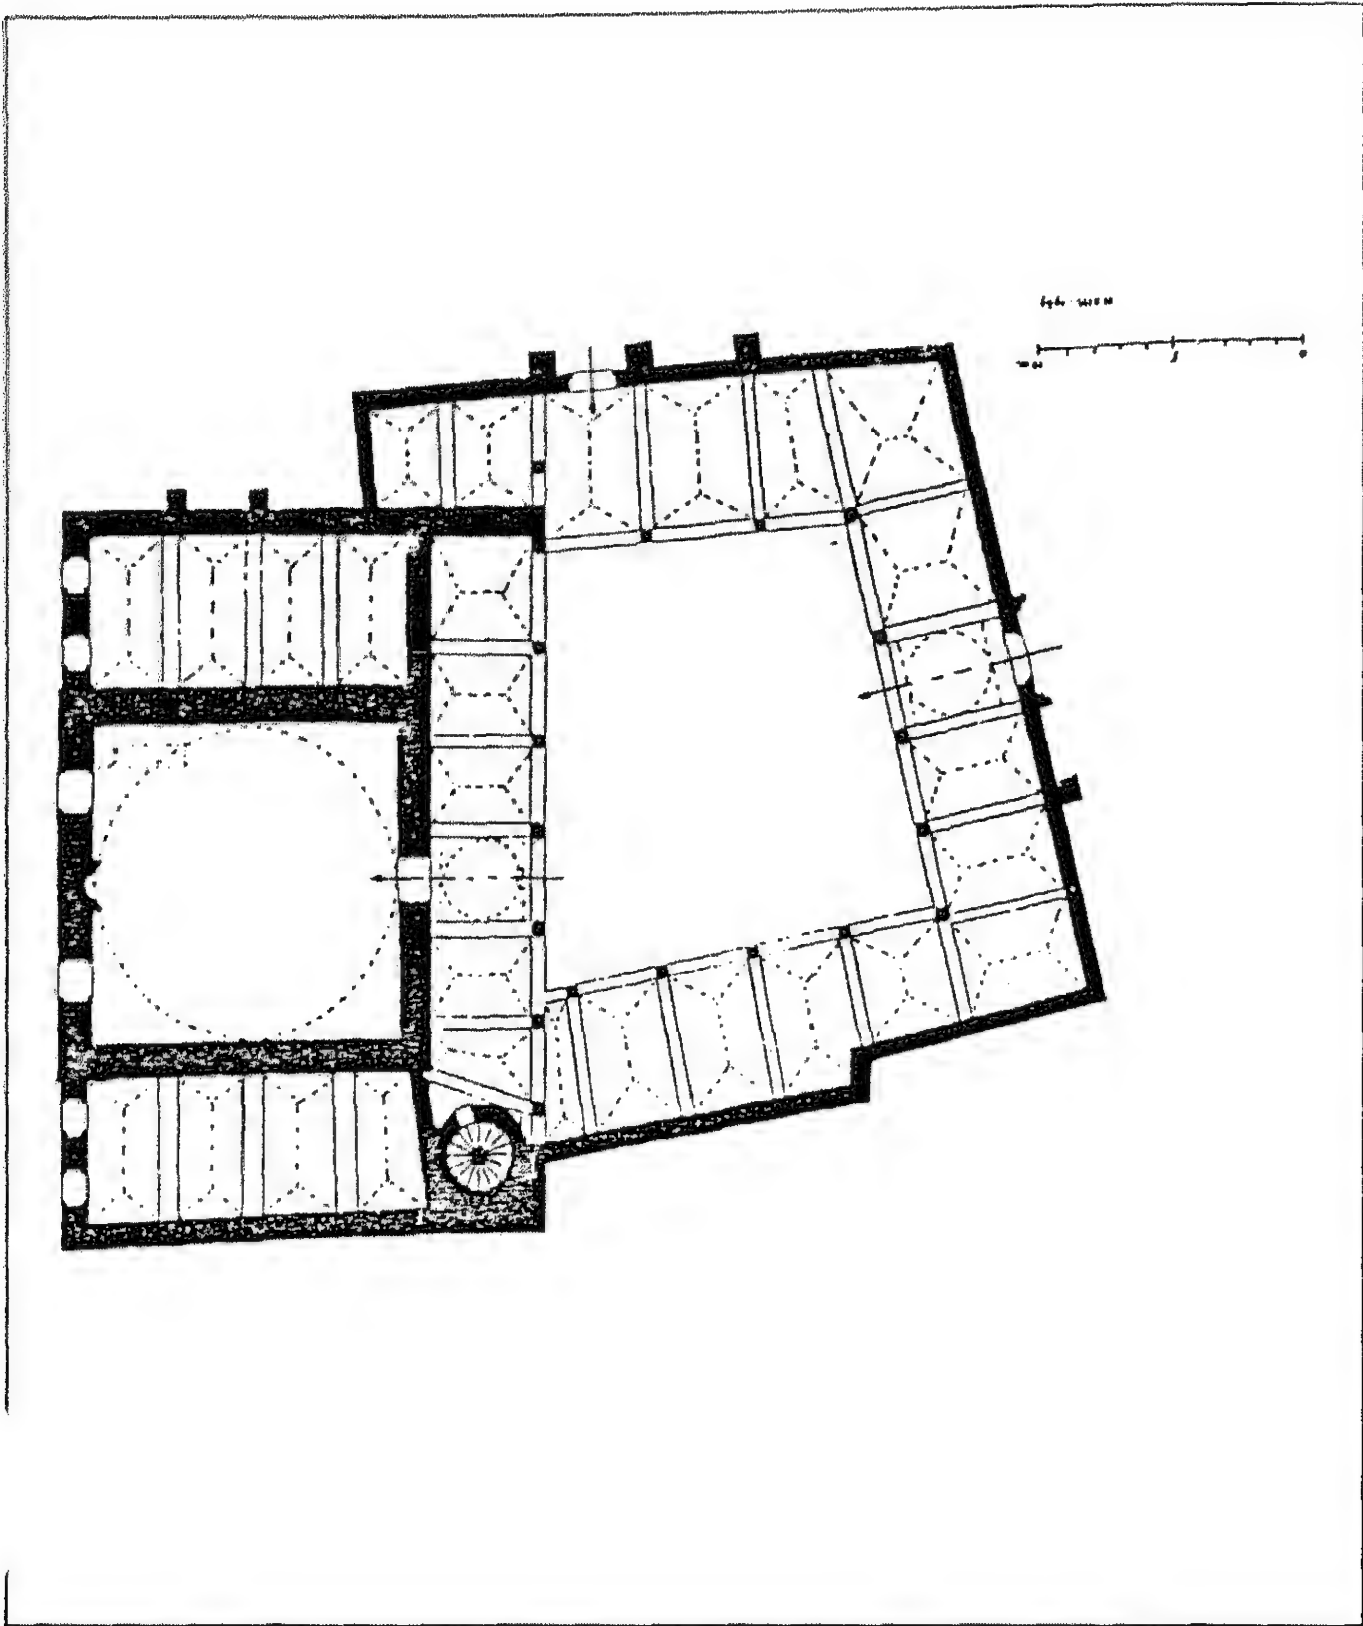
مسقط أفقي لمسجد الحسينكار في سرايفو (عن : جودوين) .
